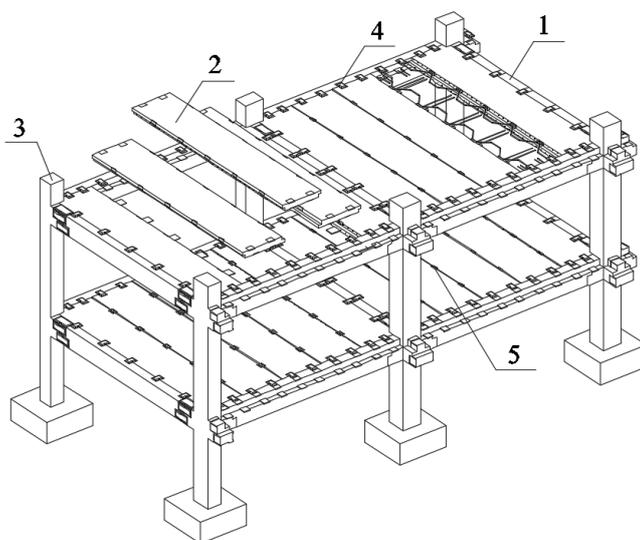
全装配式钢筋混凝土楼盖结构体系示意图
